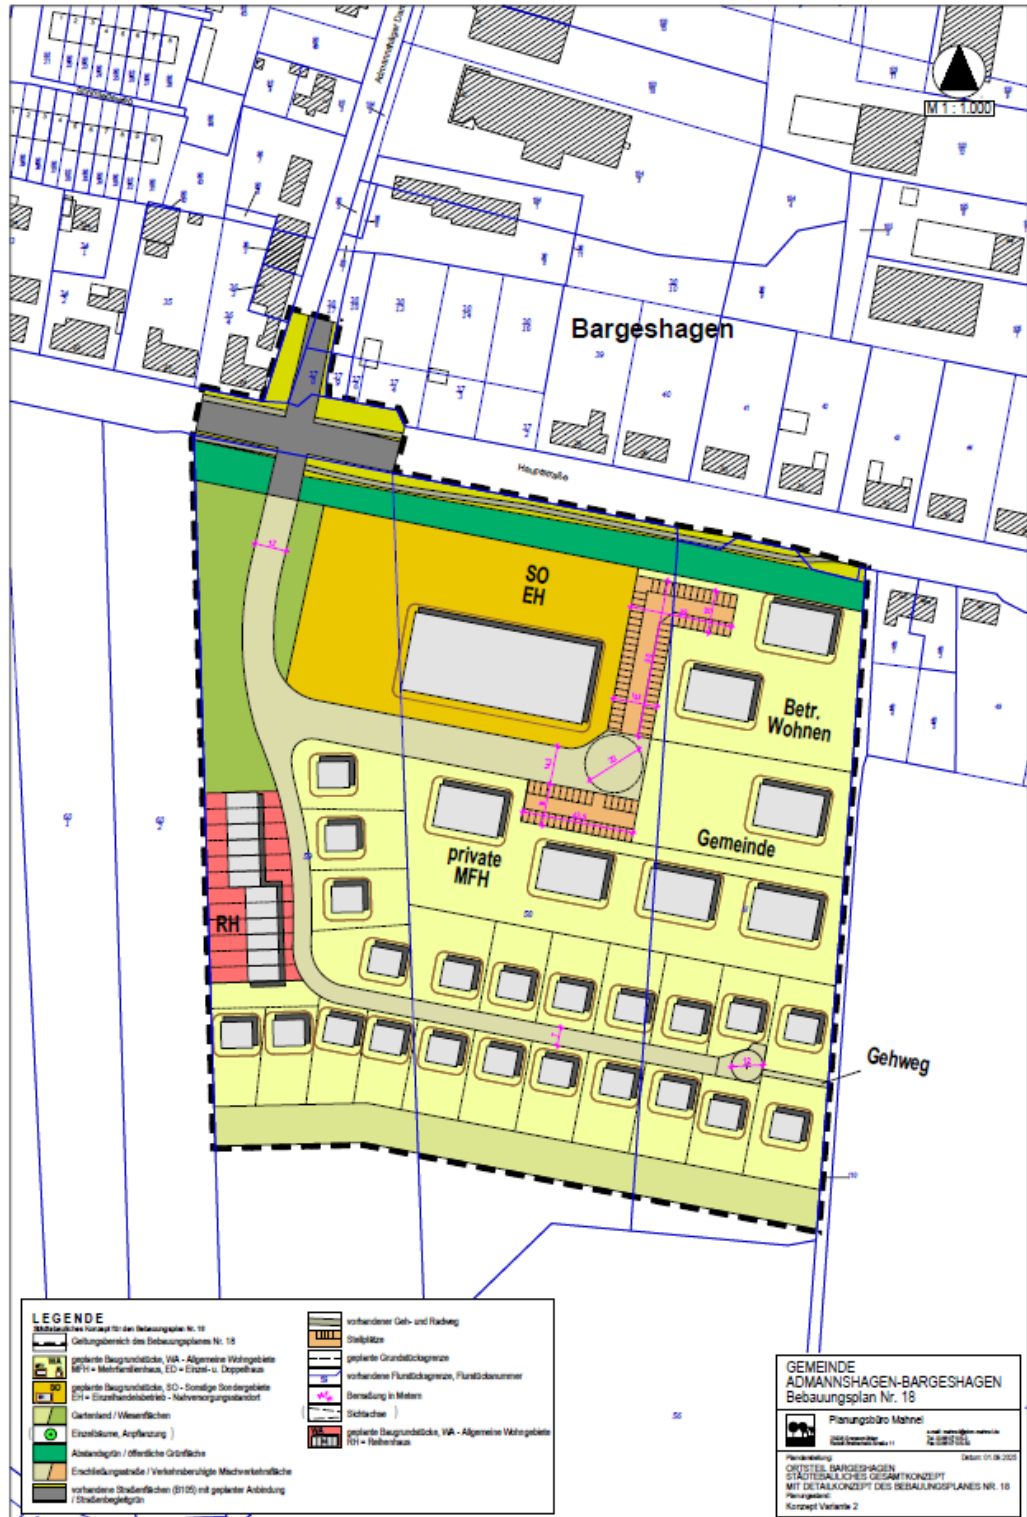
Städtebauliches Gesamtkonzept mit Detailkonzept B-Plan Nr. 18 Konzept Variante 2
